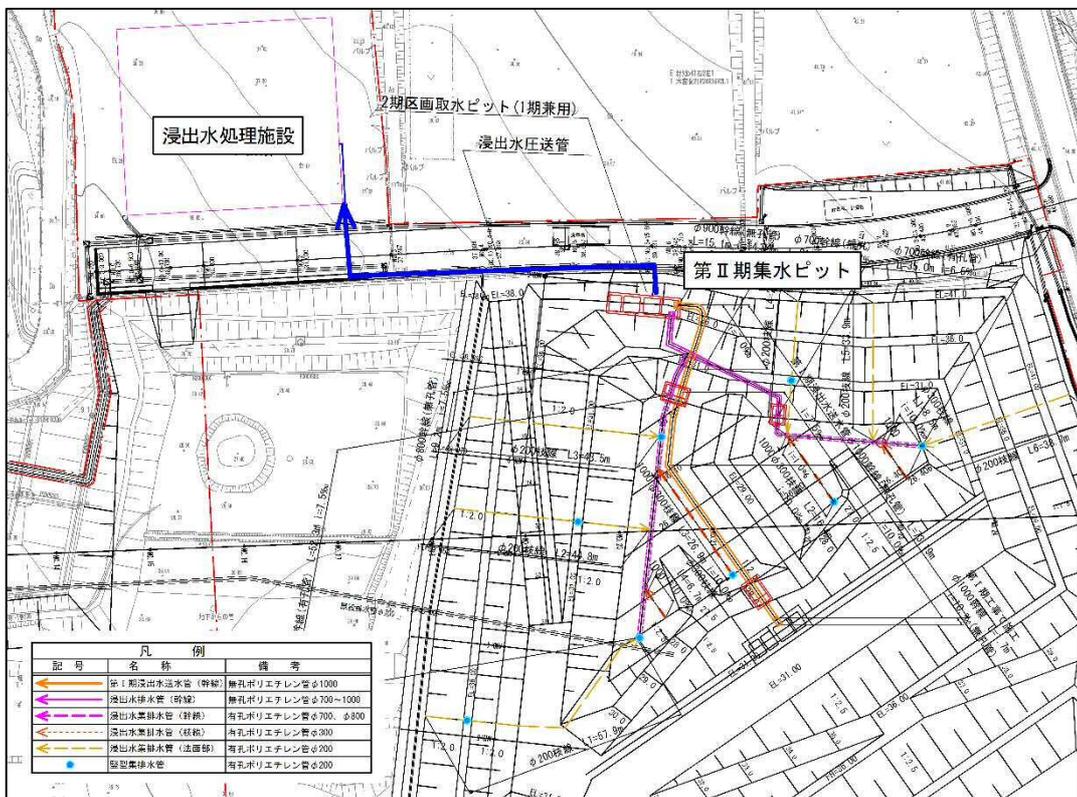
浸出水集排水施設配置計画平面図 (第Ⅱ期)
